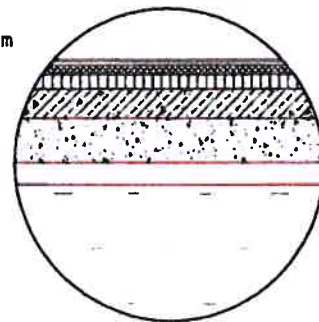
Detail A - STUDIED ROAD STRUCTURES / Detaliu A - STRUCTURI RUTIERE STUDIATE
